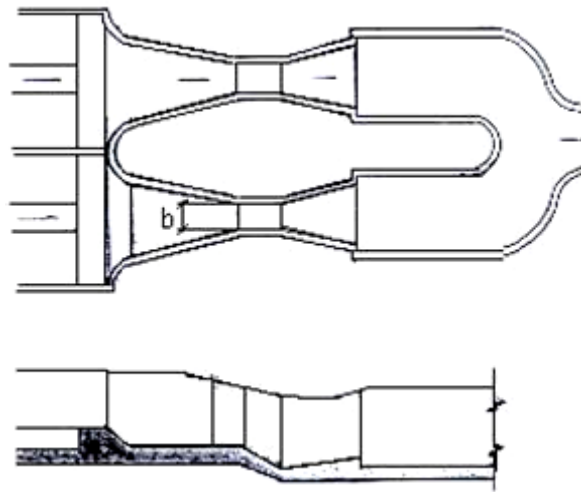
Sección parabólica del Parshall, Planta y Corte
